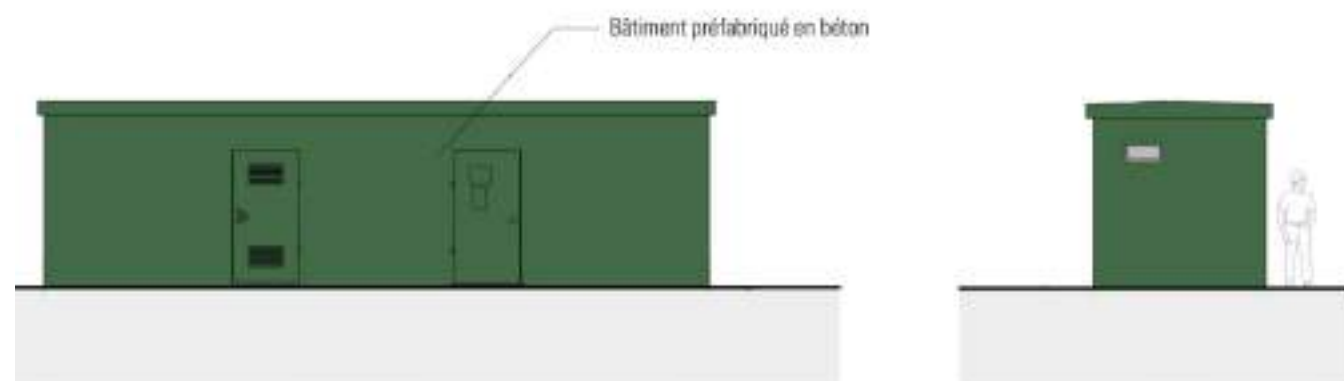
Vues des façades d'un poste transformateur tel que prévu sur site
